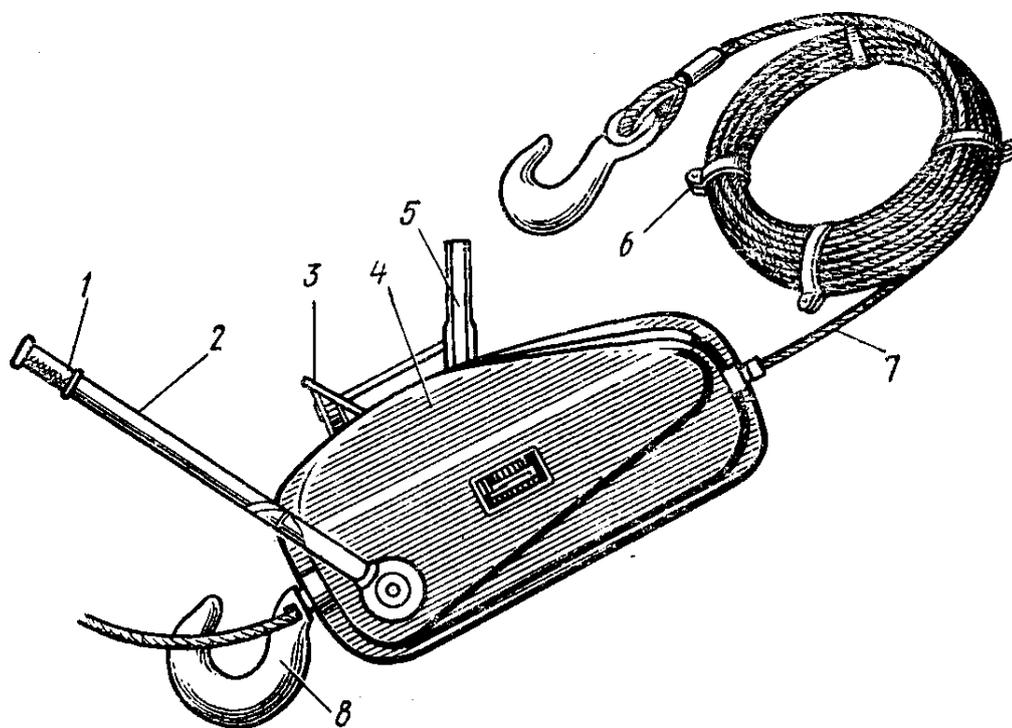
Лебедка с ручным рычажным приводом: 1 — рычаг; 2,5 — рукоятки переднего и заднего хода; 3 — оттяжка для заправки каната; 4 — тяговый механизм; 6 — хомут; 7,8 — канат с крюком
